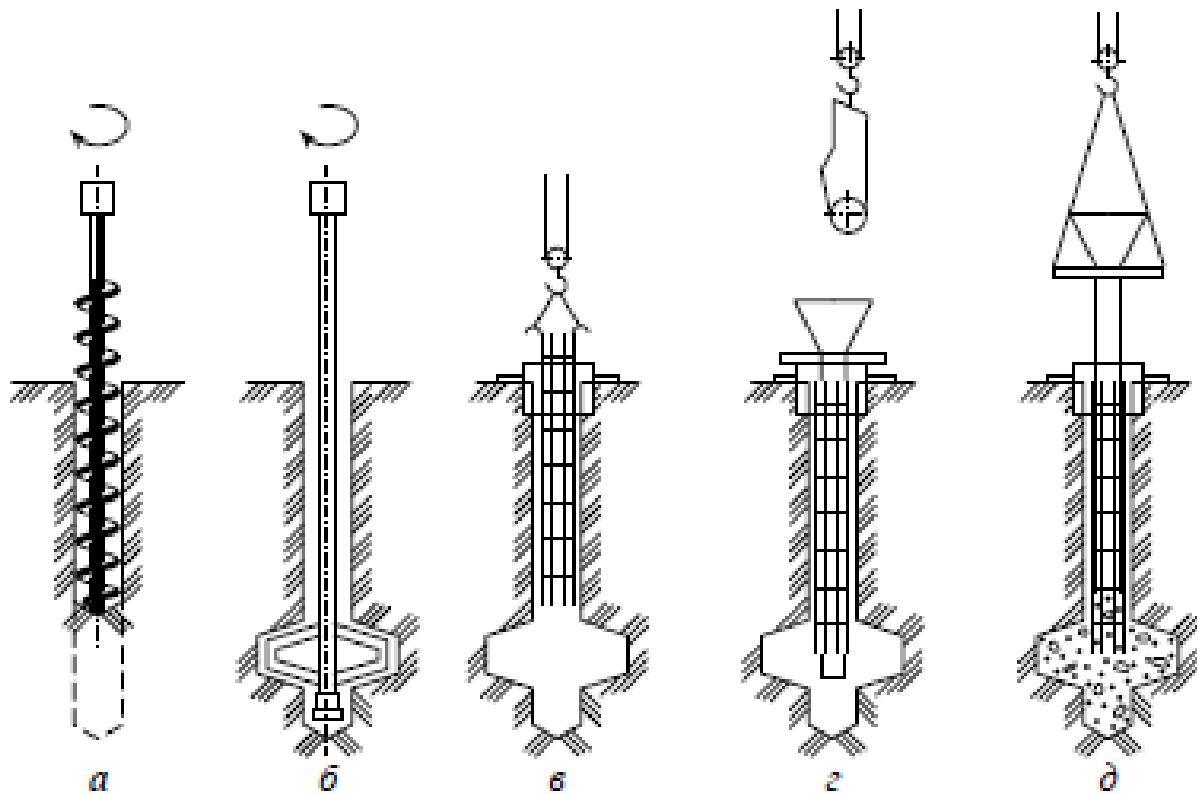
Технологічна схема виготовлення буронабивних паль із розширеною п'ятою у стійких ґрунтах: а – шнекове буріння; б – улаштування розширення механічним розширювачем; в – опускання арматурного каркаса; г – установлення бетонолитної труби; д – бетонування сердловини та витягання бетонолитної труби
